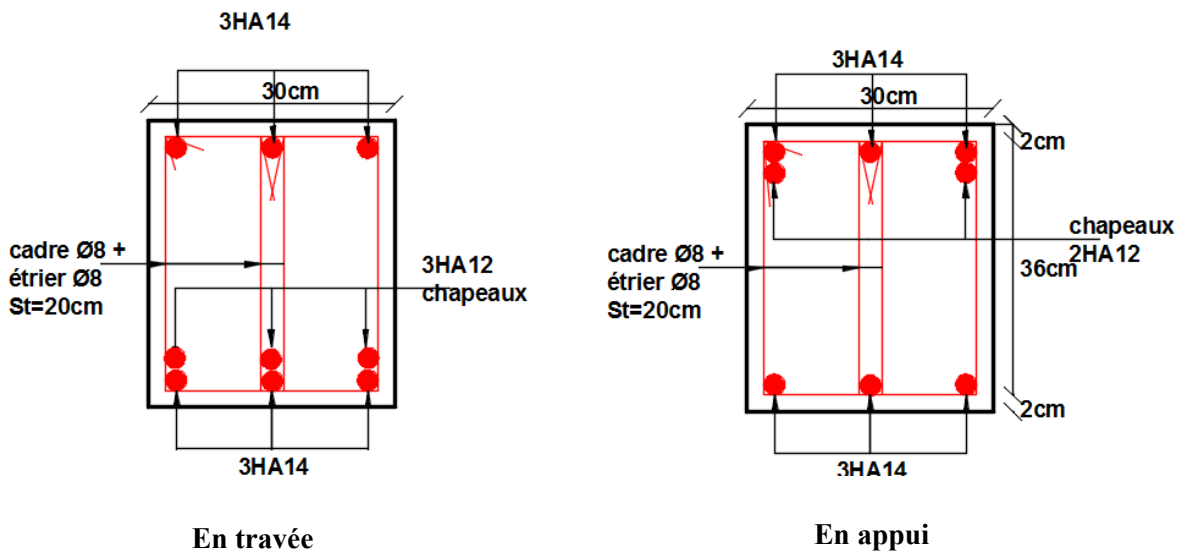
Schéma de ferrailage des Poutres Principales étages courants
